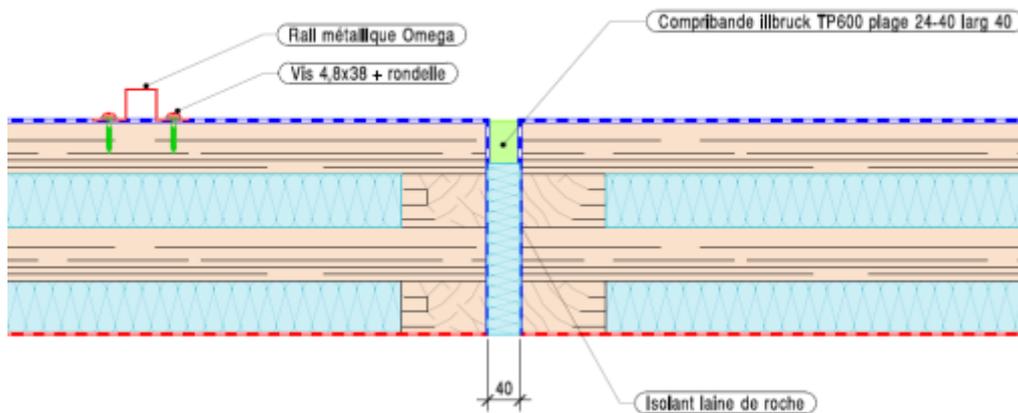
Essai AEV Jonction verticale entre Panobloc et oméga support de parement / coupe horizontale
